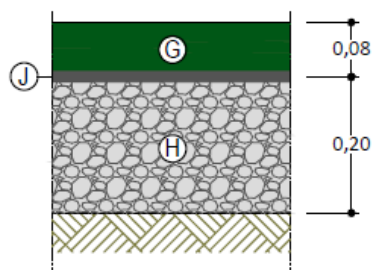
Pormenor do pavimento tipo VI - Ciclovia
